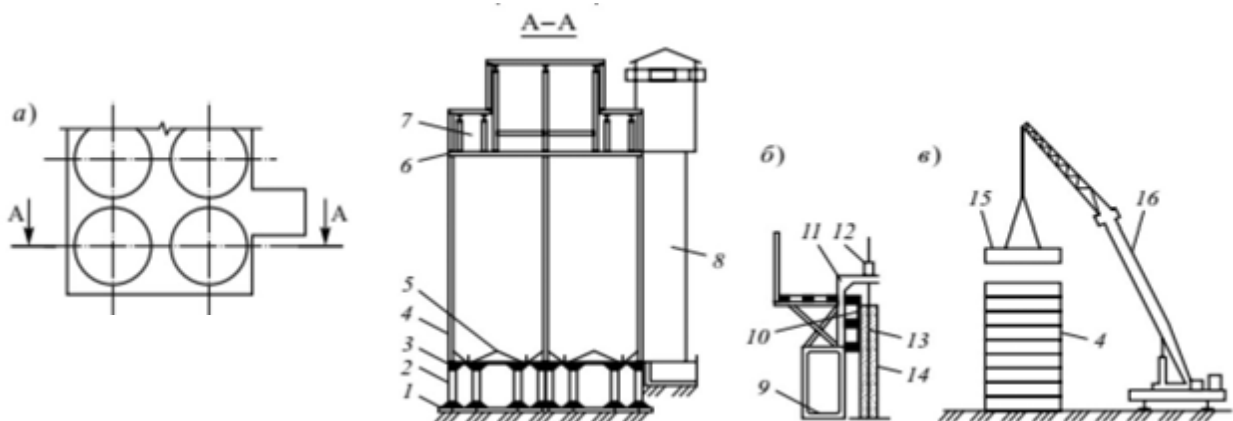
Залізобетонні силоси: а – конструкція силосу (план та розріз); б, в - пристрій монолітніх банок і збірних залізобитонних силосів; 1 – фундаментна плита; 2 – несучі колони; 3, 6 – під силосне та над силосне перекриття; 4 – силосна банка; 5 – укоси; 7 – над силосна галерея; 8 – сходові клітка; 9 – риштування для затирання стін; 10 – опалубка; 11 – домкратна рама; 12 – домкрат; 13 – домкратний стрижень; 14 – стіна; 15 – кільце; 16 – кран
